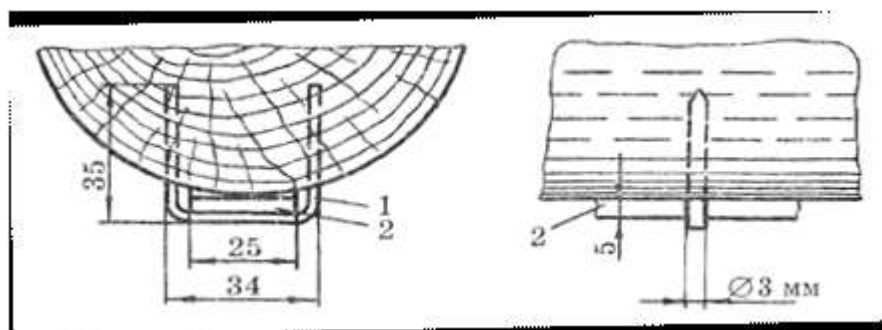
Схема кріплення заземлювального провідника у виробці з дерев'яним кріпленням:
